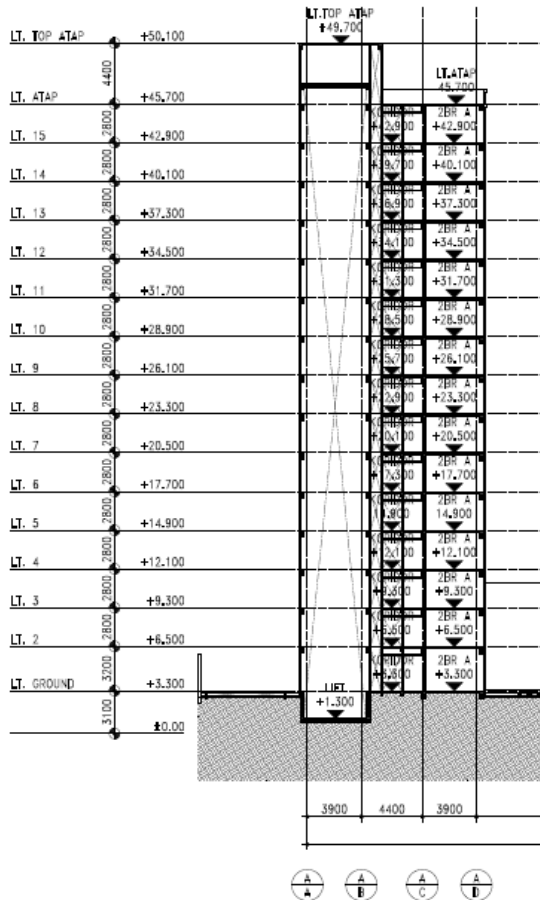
2 Denah Gedung Apartemen Gunawangsa
